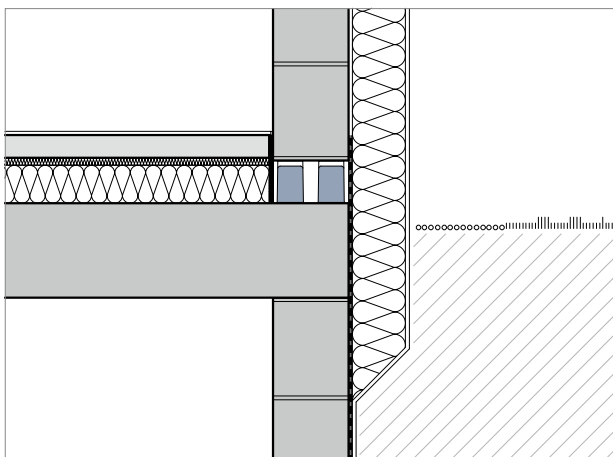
Schöck Sconnex® Typ M in Mauerwerk bei Außenwand und Aufdeckendämmung
